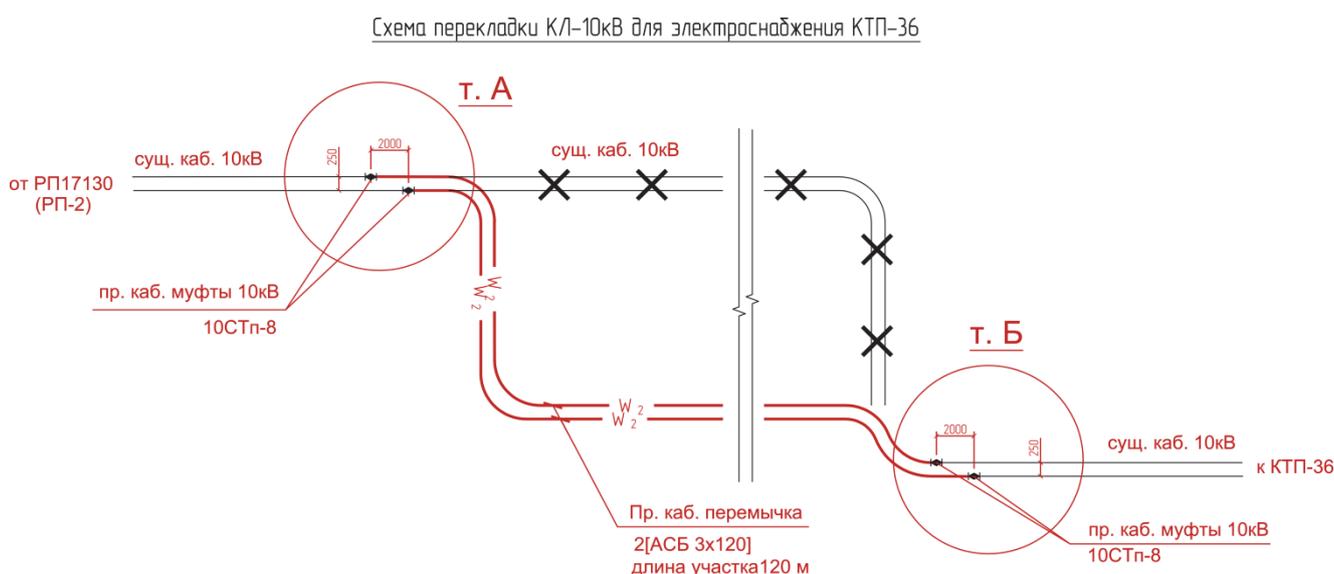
Пример оформления схемы перекладки кабельных линий
